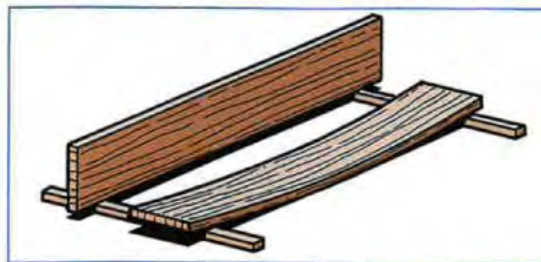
Plank horizontaal met doorbuiging en verticaal zonder doorbuiging
